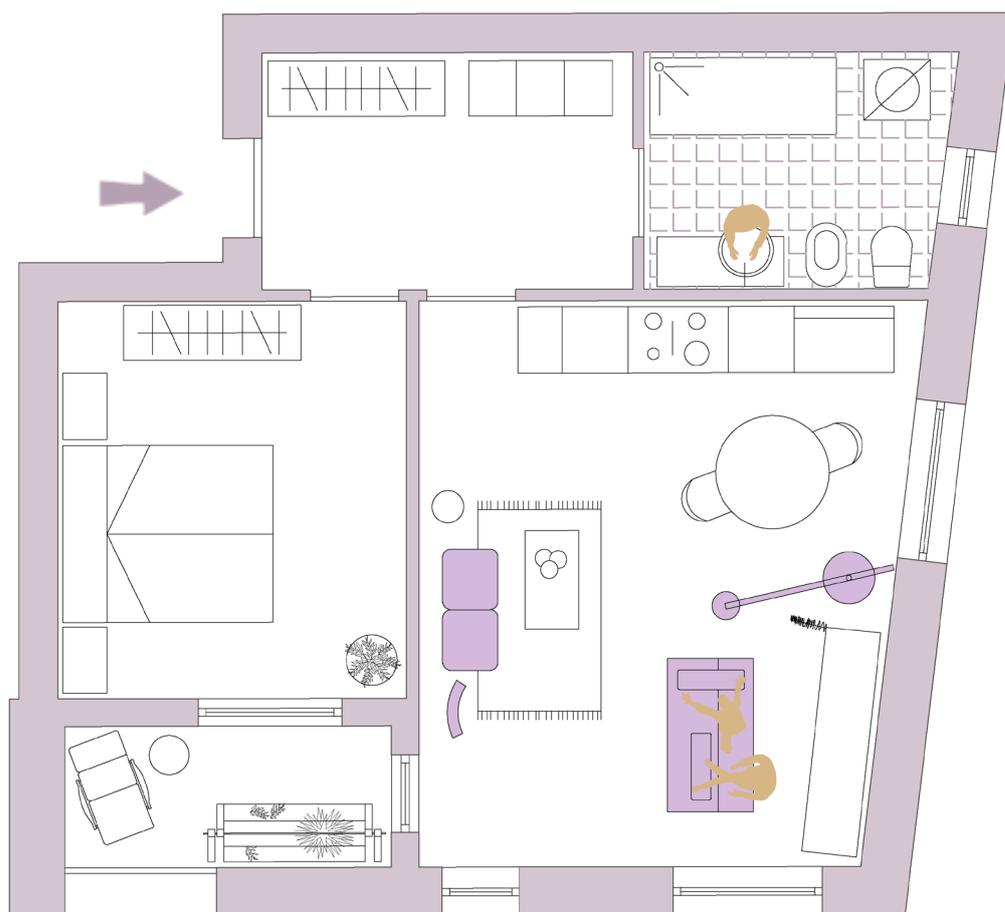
Rappresentazione planimetrica soluzione ambiente fitness / yoga.
